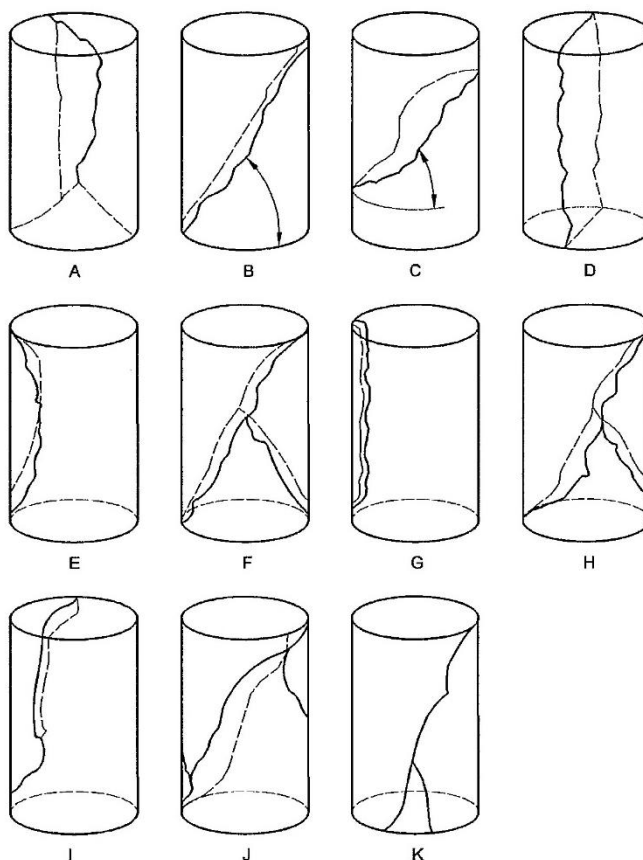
Exemples de ruptures incorrectes d'éprouvettes cylindriques
